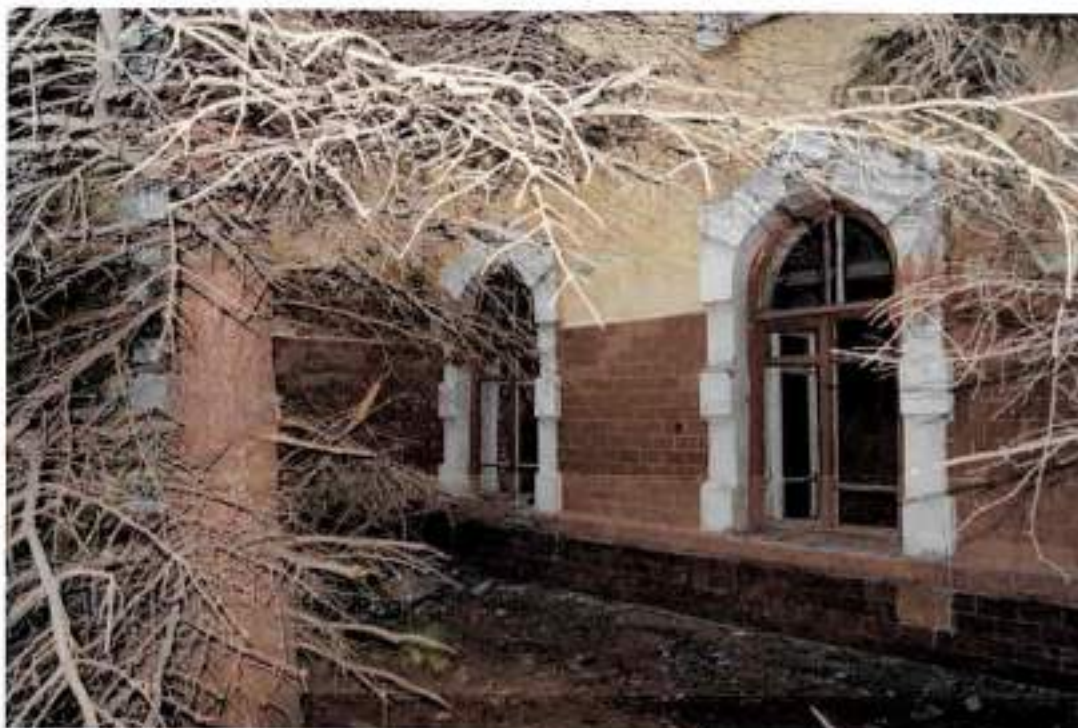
Вид на арочные оконные проемы на 1-м этаже правого крыла главного фасада здания
